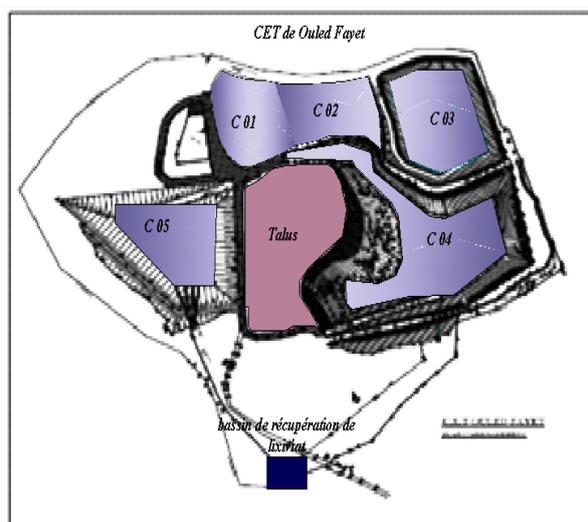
Plan de masse du CET d'Ouled Fayet (Source : AMENHID, 2008).
